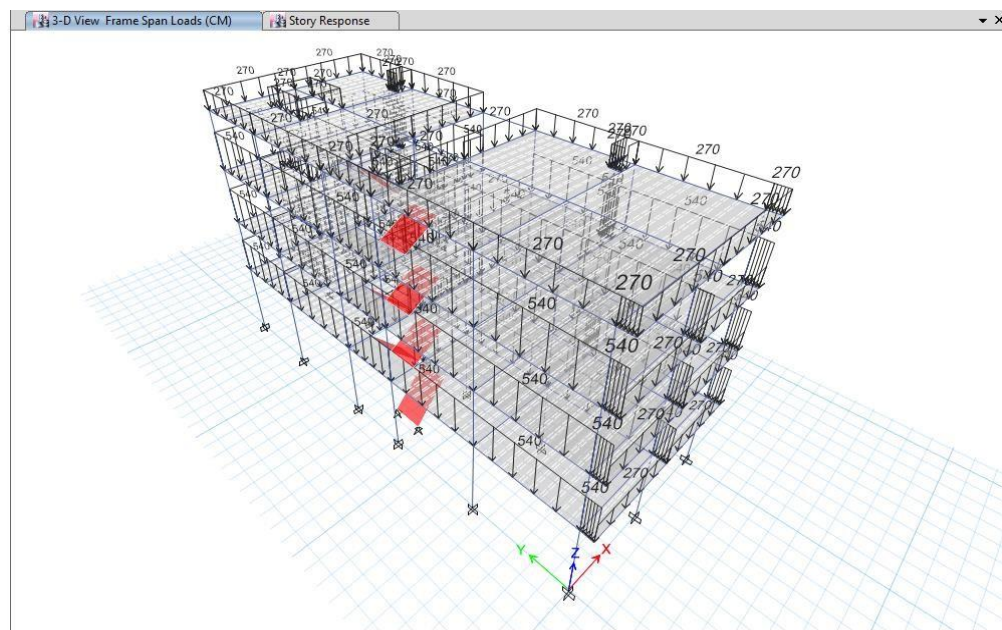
Carga distribuida en vigas por tabiquería en unidad tonf.
